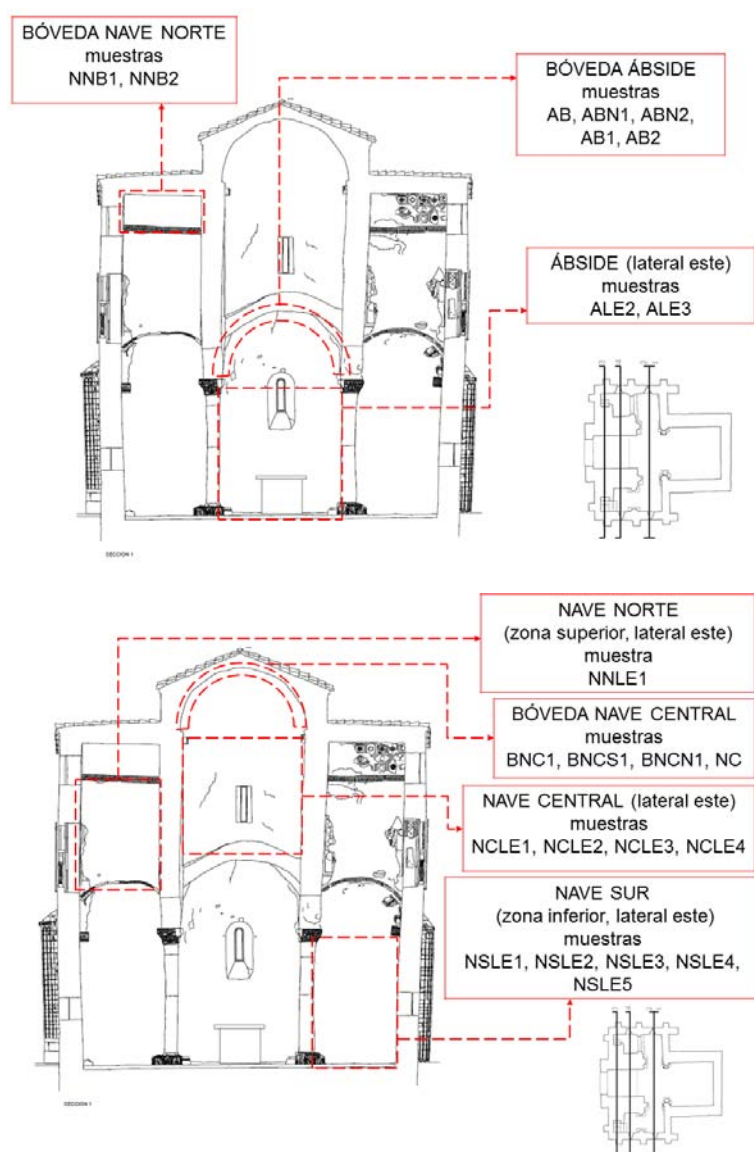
Localización en alzados de las muestras recogidas en el ábside, nave norte, nave sur, nave central y altar.
